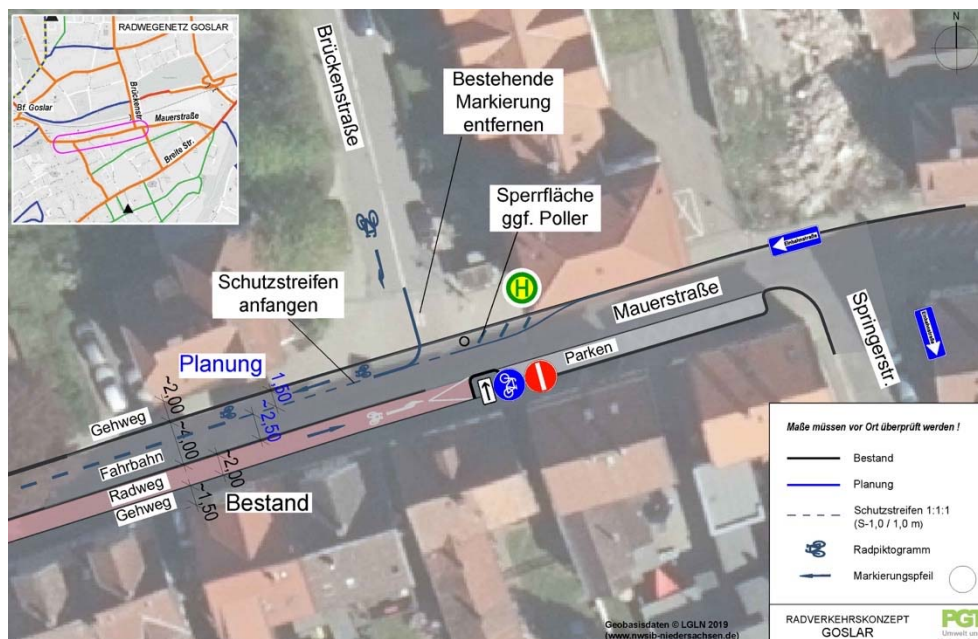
Kurzfristige Umbaumöglichkeiten Mauerstraße / Brückenstraße (Markierungen)
